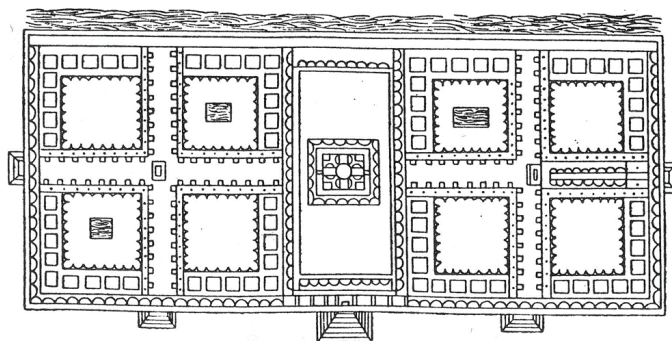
Pianta dell'Ospedale disegnata da Filarete, 1456.
